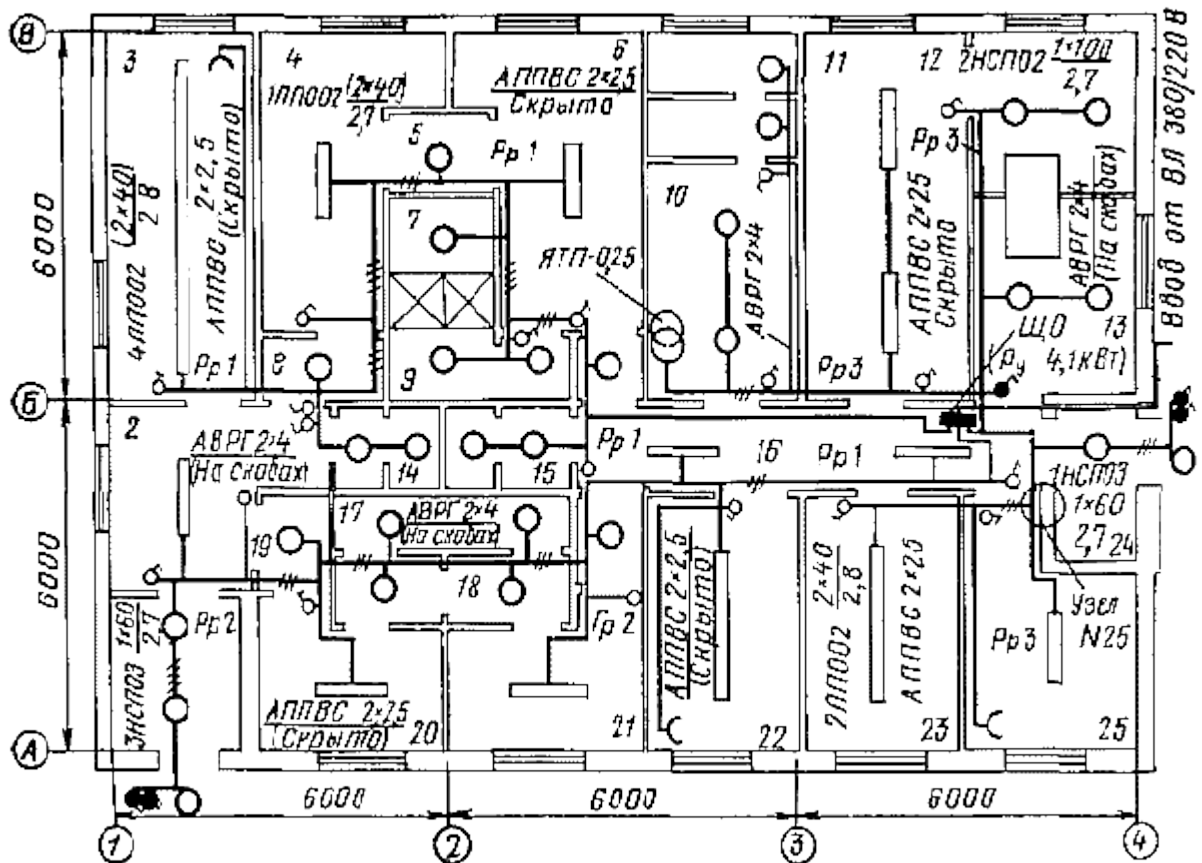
Электрическая схема осветительной электропроводки на плане санитарного пропускника
